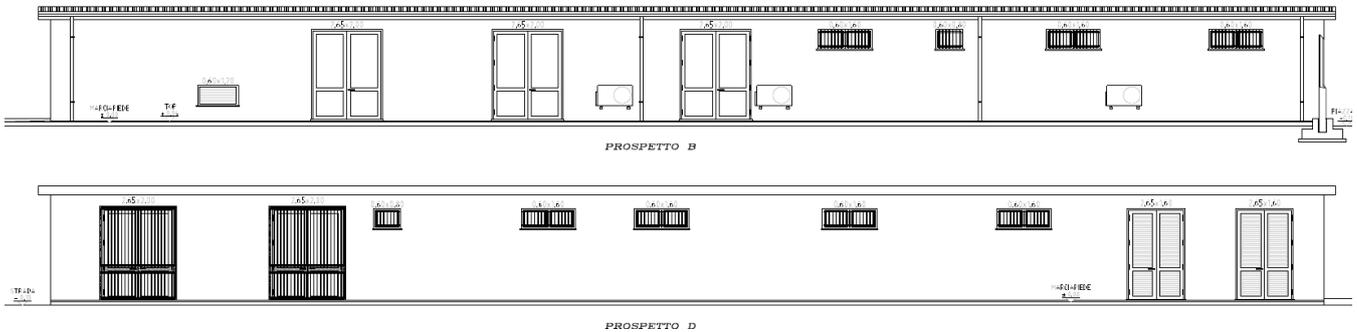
Prospetto dello shelter locali di consegna (SSU)
